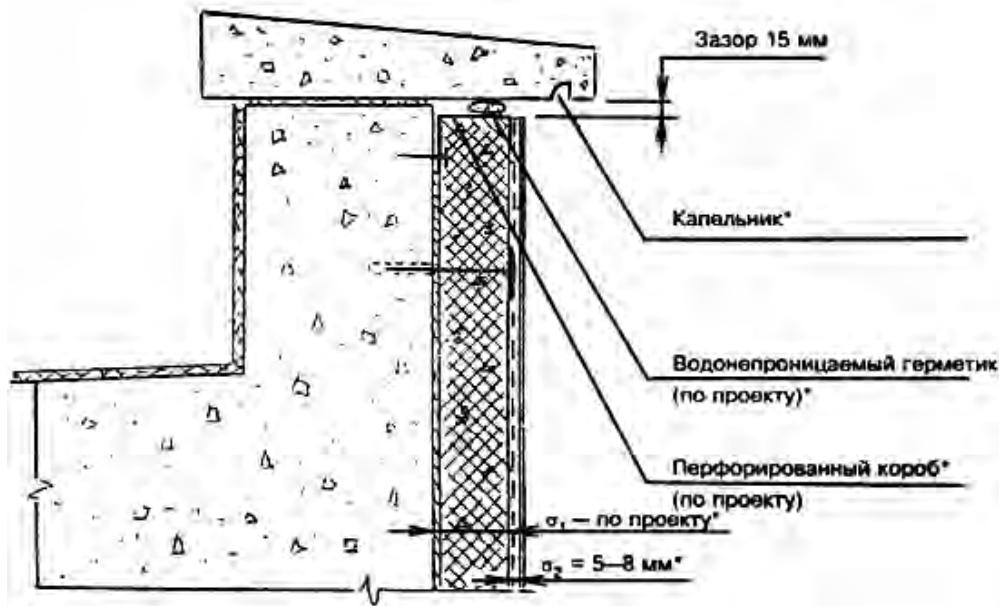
Фрагмент примыкания наружной теплоизоляции здания к карнизной плите
